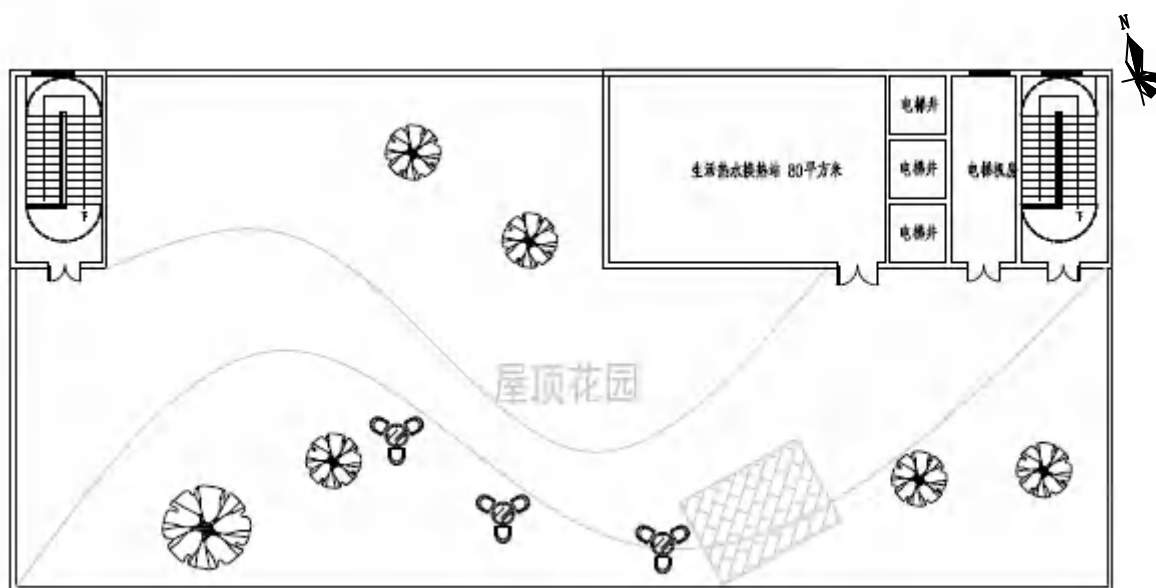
项目宿舍楼屋顶层平面布置图（比例尺：1:297）
